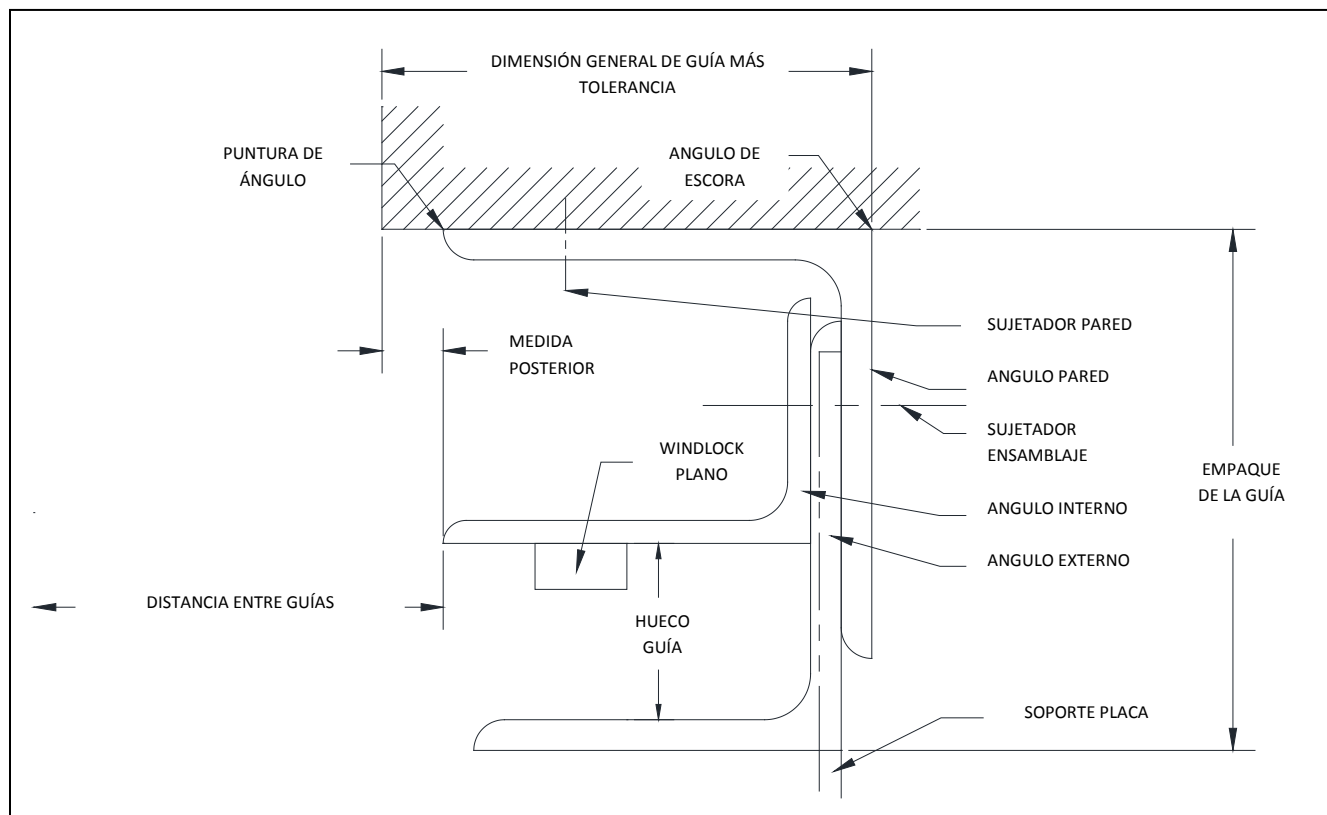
Sobre Muro con Guía “E” con Windlock Plana
